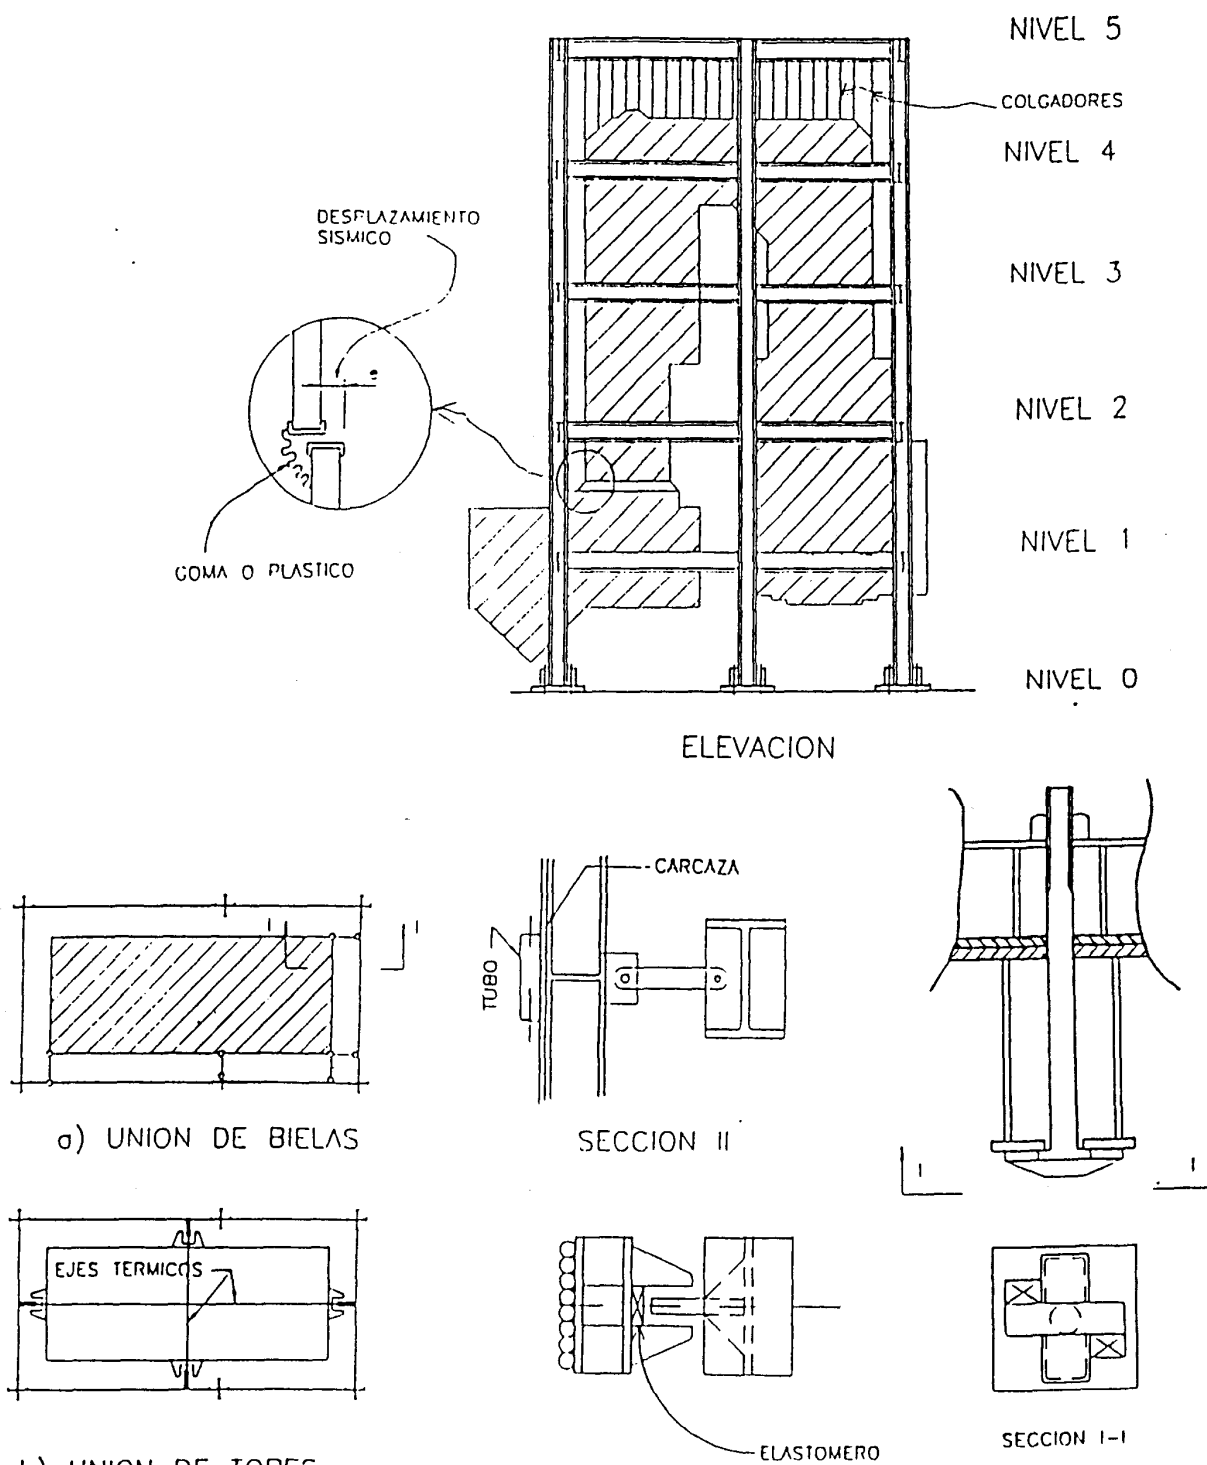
EQUIPO RIGIDO EN EDIFICIO
